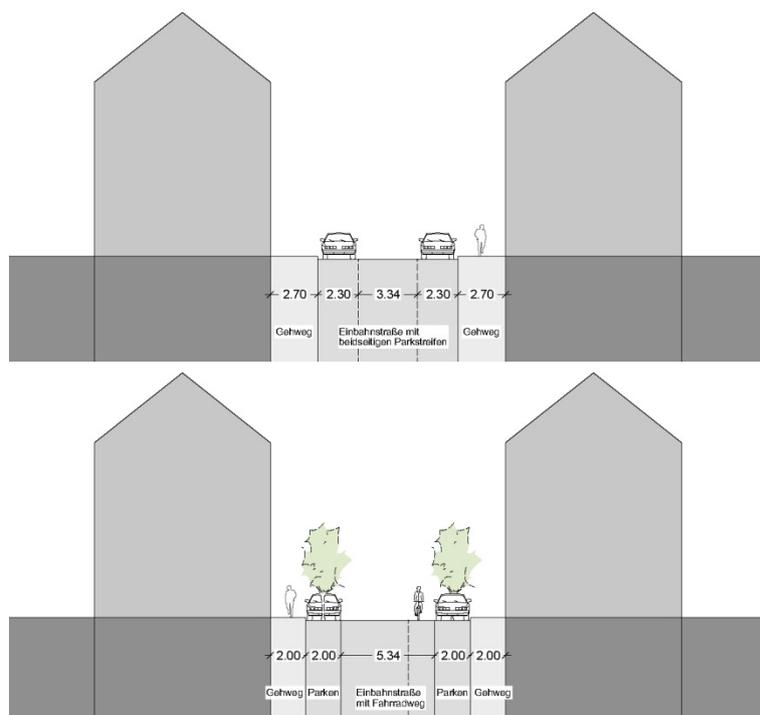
Schnitt Mittelstraße West Bestand (oben) und Planung (unten)
